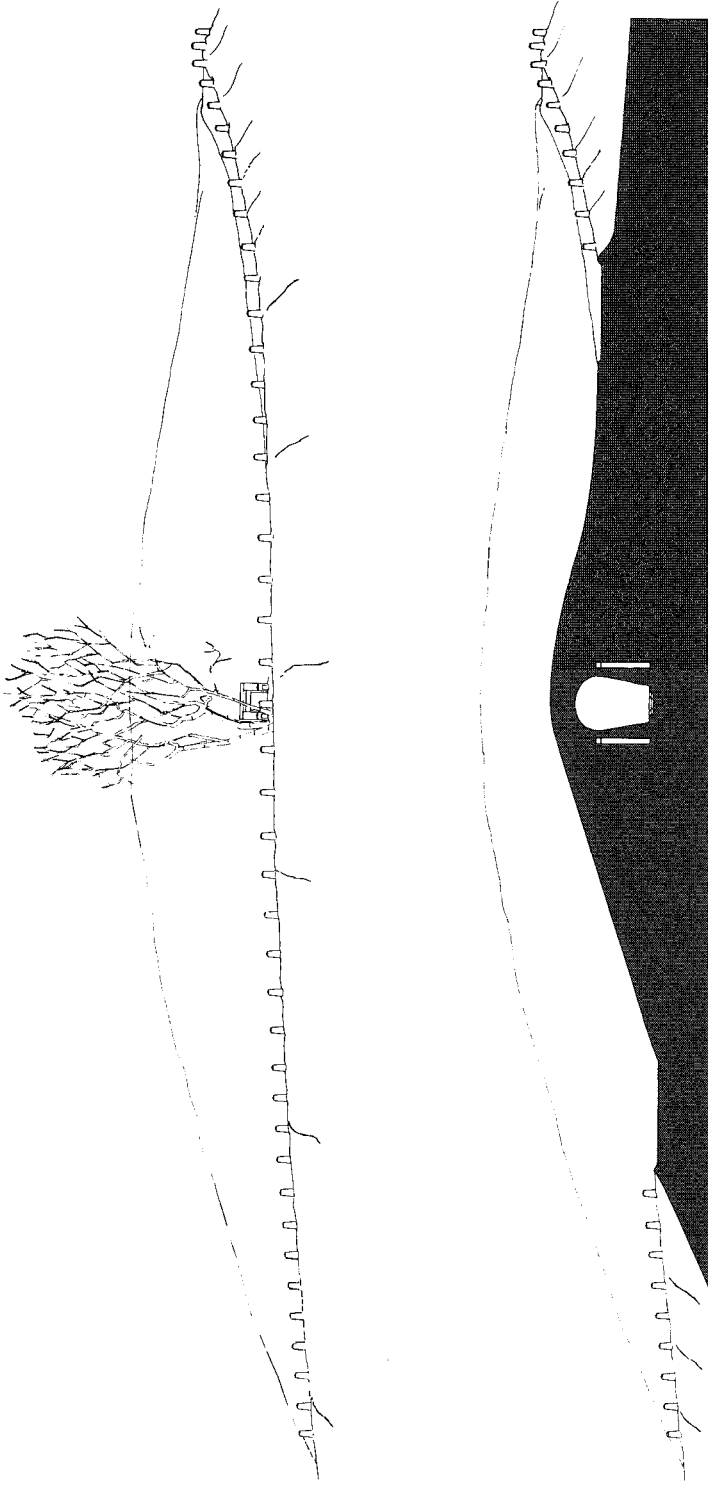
Élévation et coupe transversale de la colline. On y perçoit la forme générale de la glacière et de la zone tampon isolante. Elevation and cross section of the ice-house and the isolating surroundings are visible.
